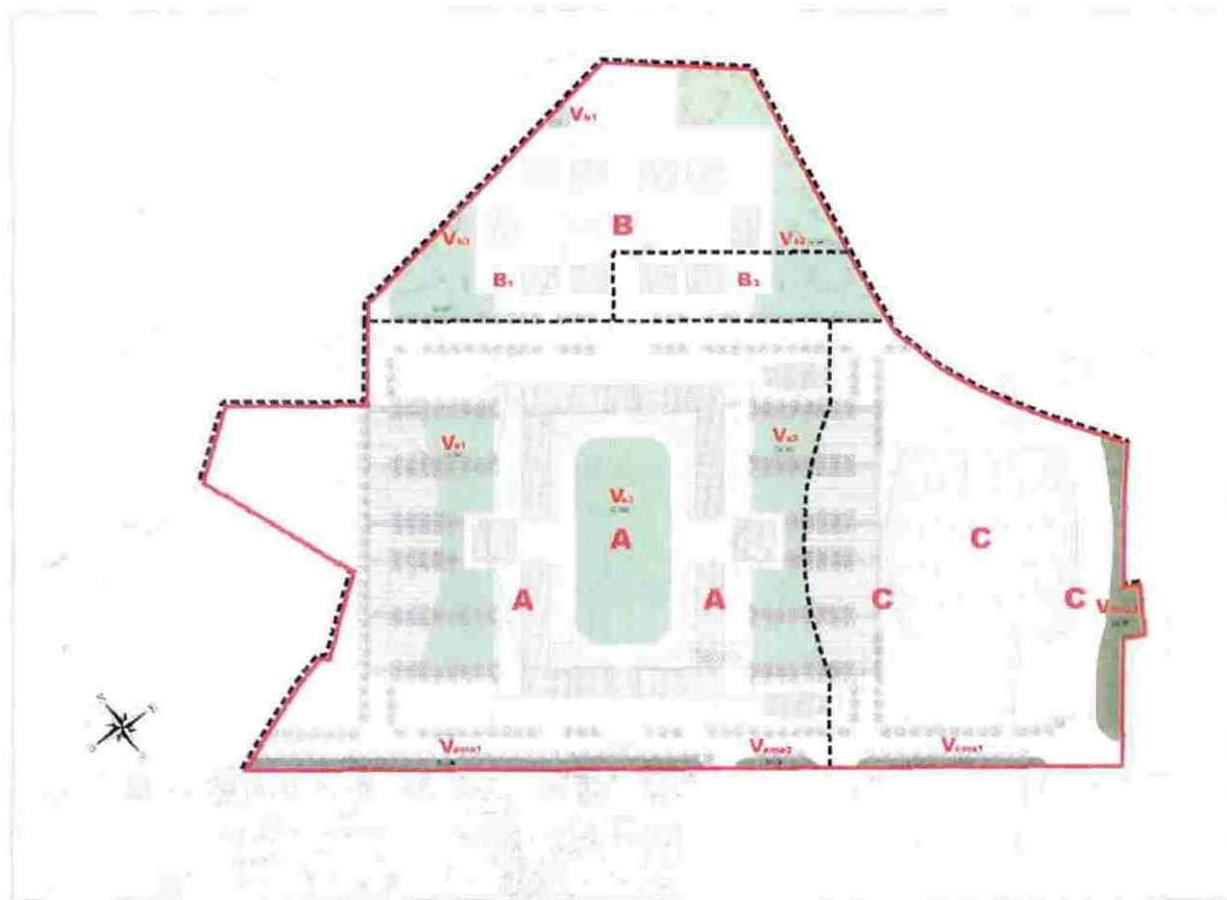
Planimetria con individuazione del sistema dei parcheggi
